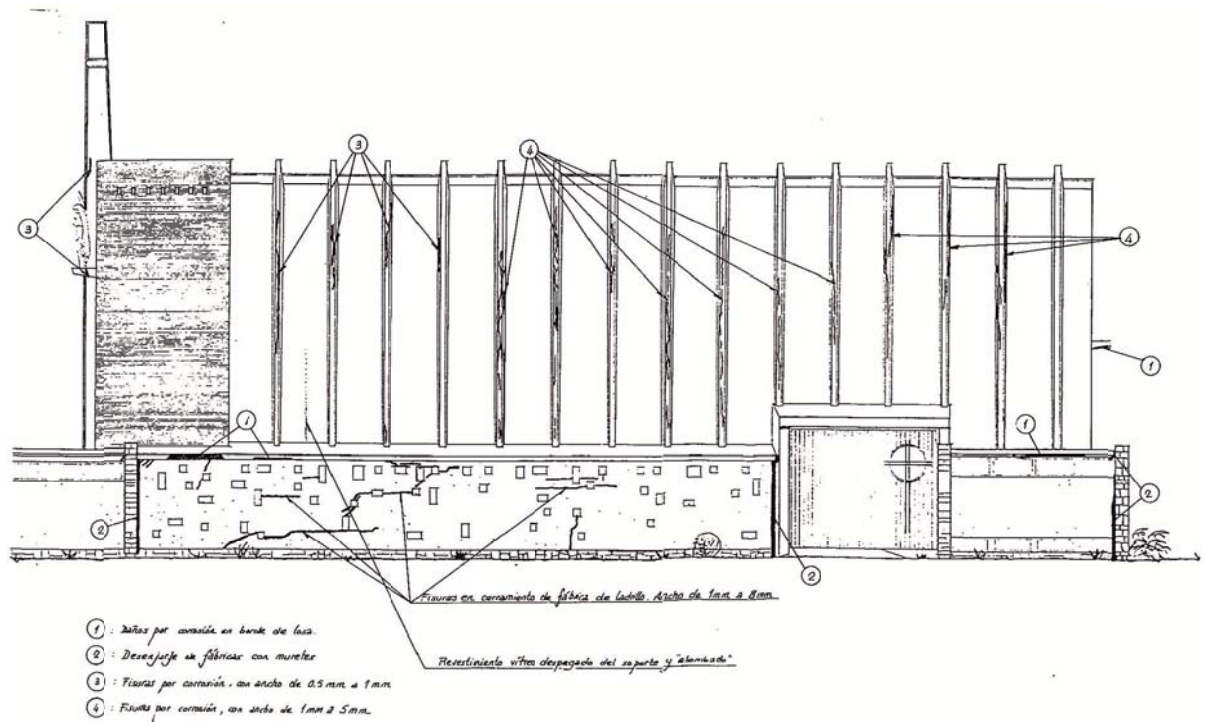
Croquis daños Fachada Sur (Fernández, J. 1999)
